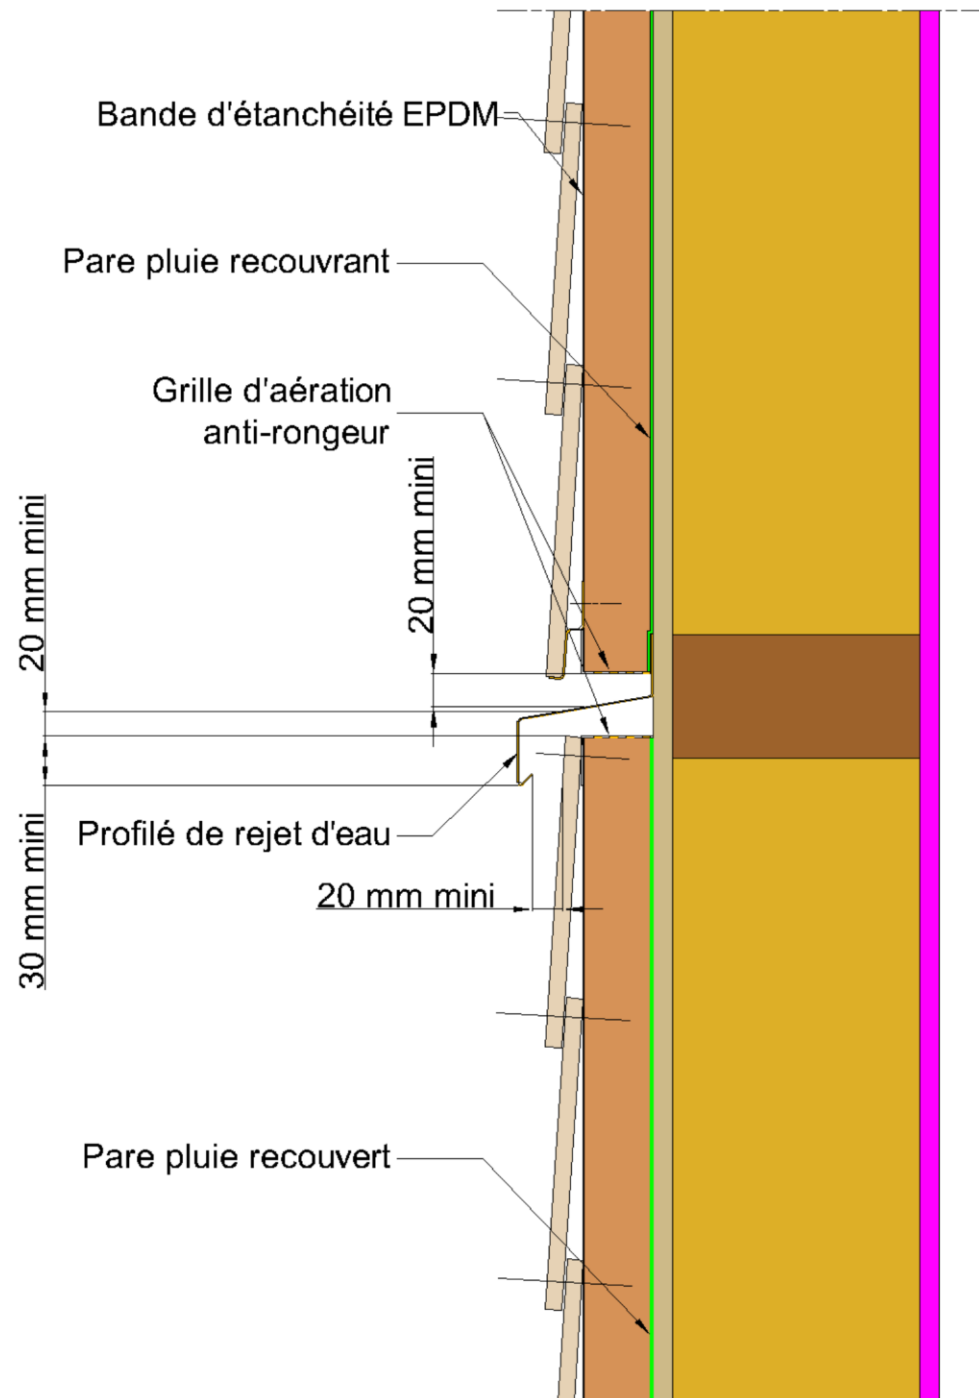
Recoupement du pare pluie tous les 6 m de hauteur
